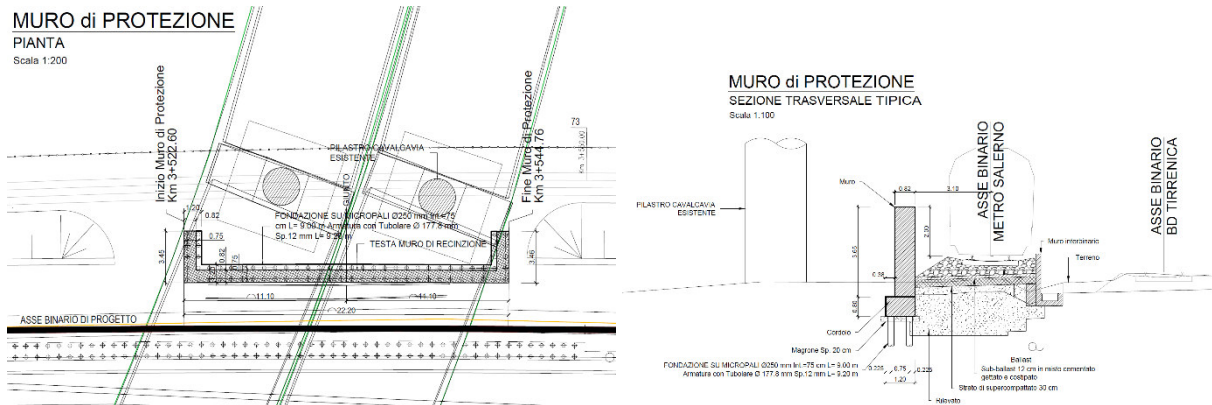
Opera di protezione cavalcaferrovia pk 3+530 (pianta e sezione)
